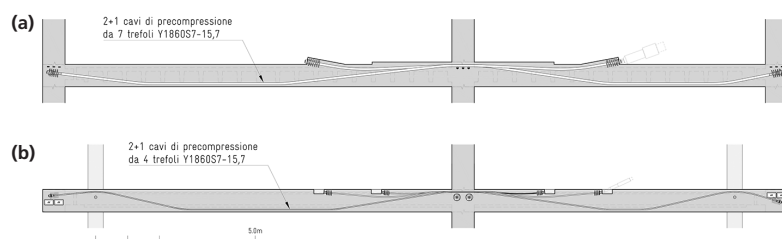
Particolare della precompressione: a) di una nervatura centrale e b) di una nervatura perimetrale. Detail of the prestressing: a) of a central rib and b) of a perimeter rib.
